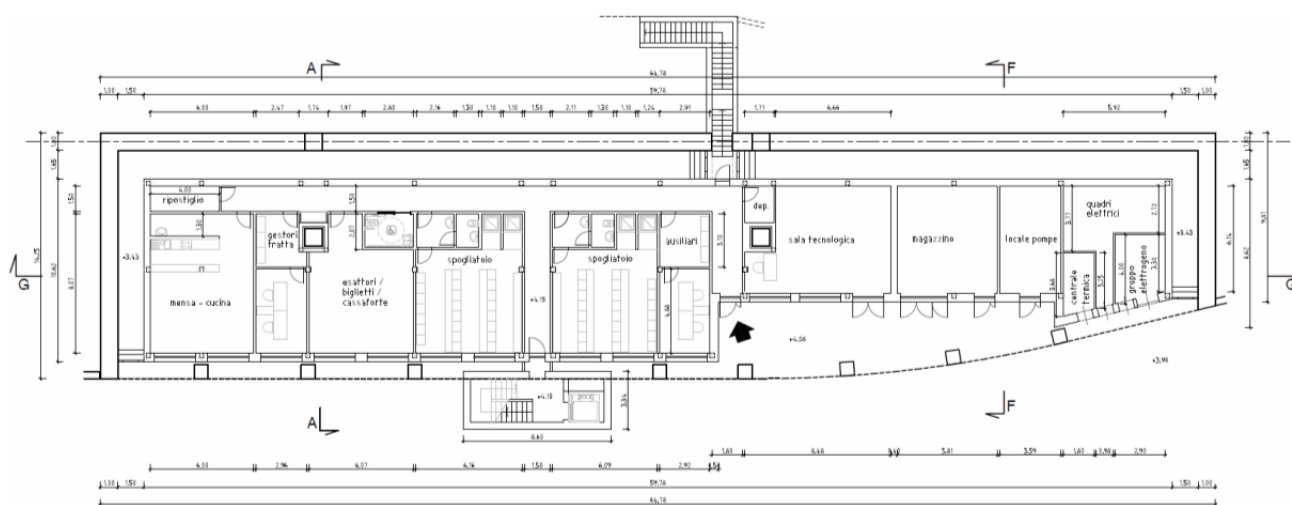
Pianta del nuovo fabbricato di stazione seminterrato (tratta dalla tavola I.00.05.0.0).
